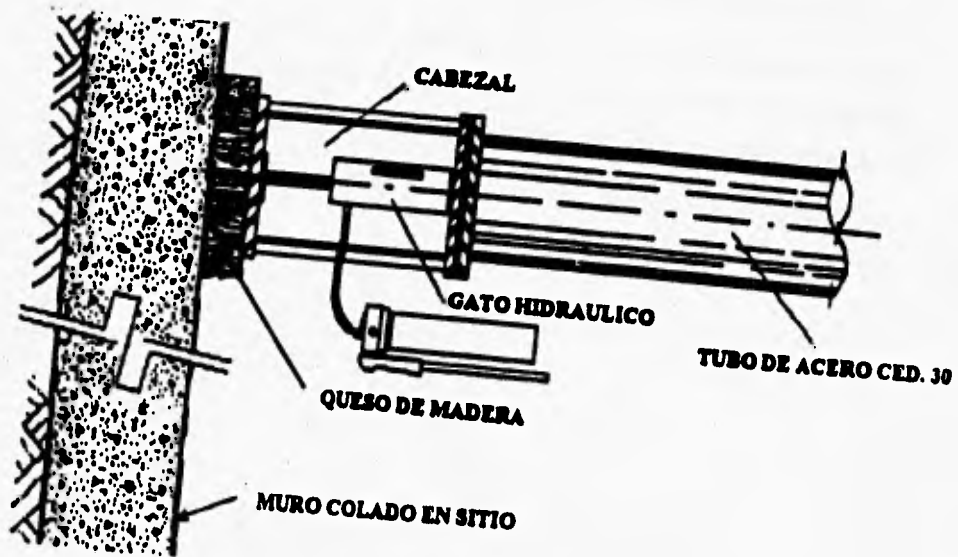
Detalle del apoyo del troquel sobre el muro.
